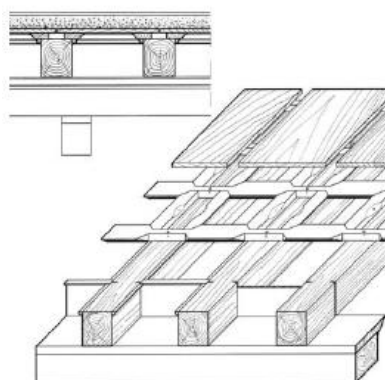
Axonometría forjado de casetones típico (Diodato, 2009).
